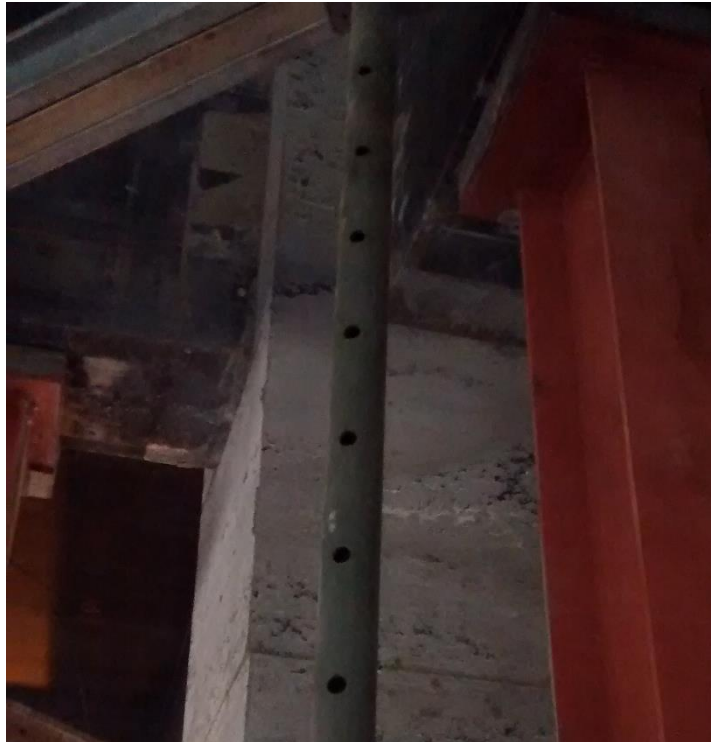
Detalhe recuperação de um dos pilares. (Fonte: Dos autores 2016)
